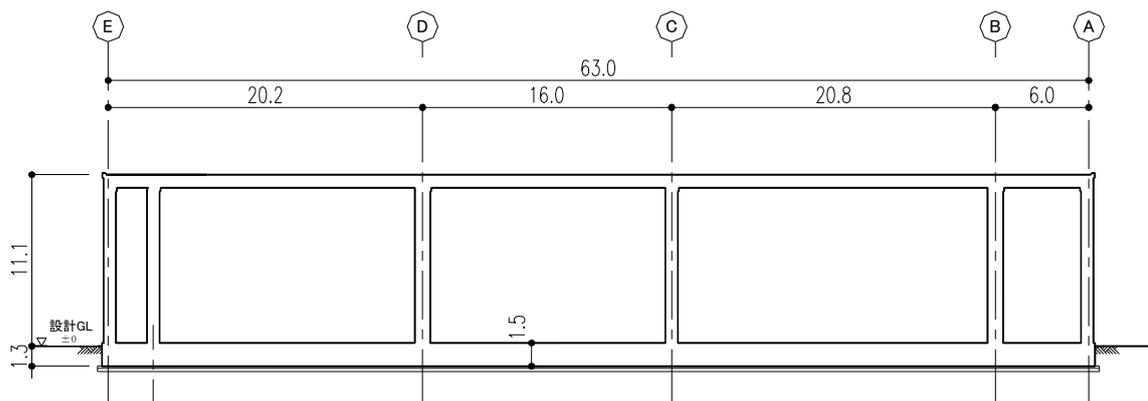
スラッジ棟 B-B断面図 (EW 方向) (単位 : m)
